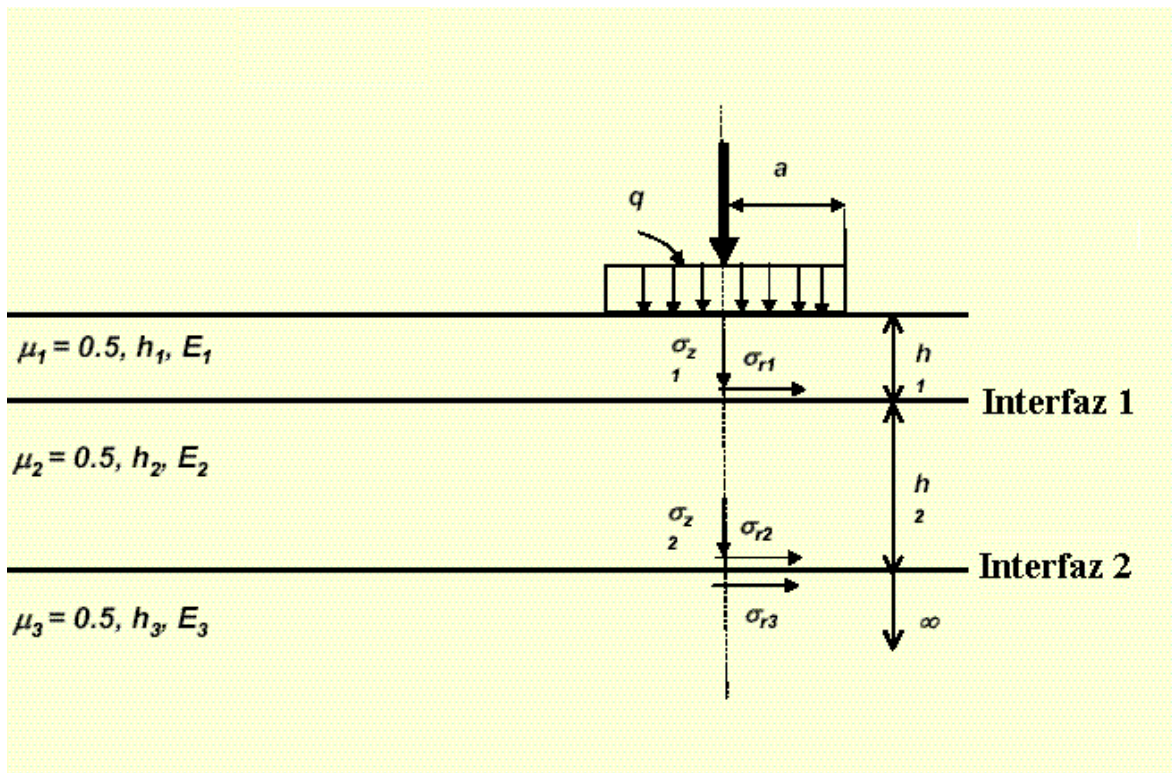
b.29 Sistema de tres capas pavimento flexible.
